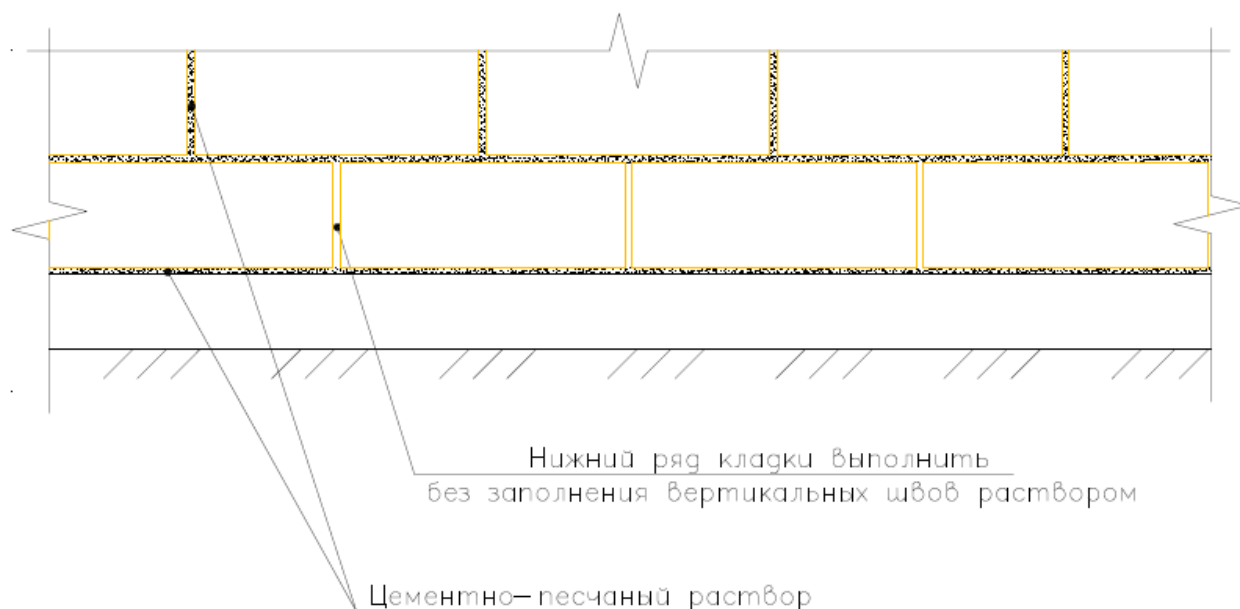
Фрагмент кладки нижнего ряда облицовки.
